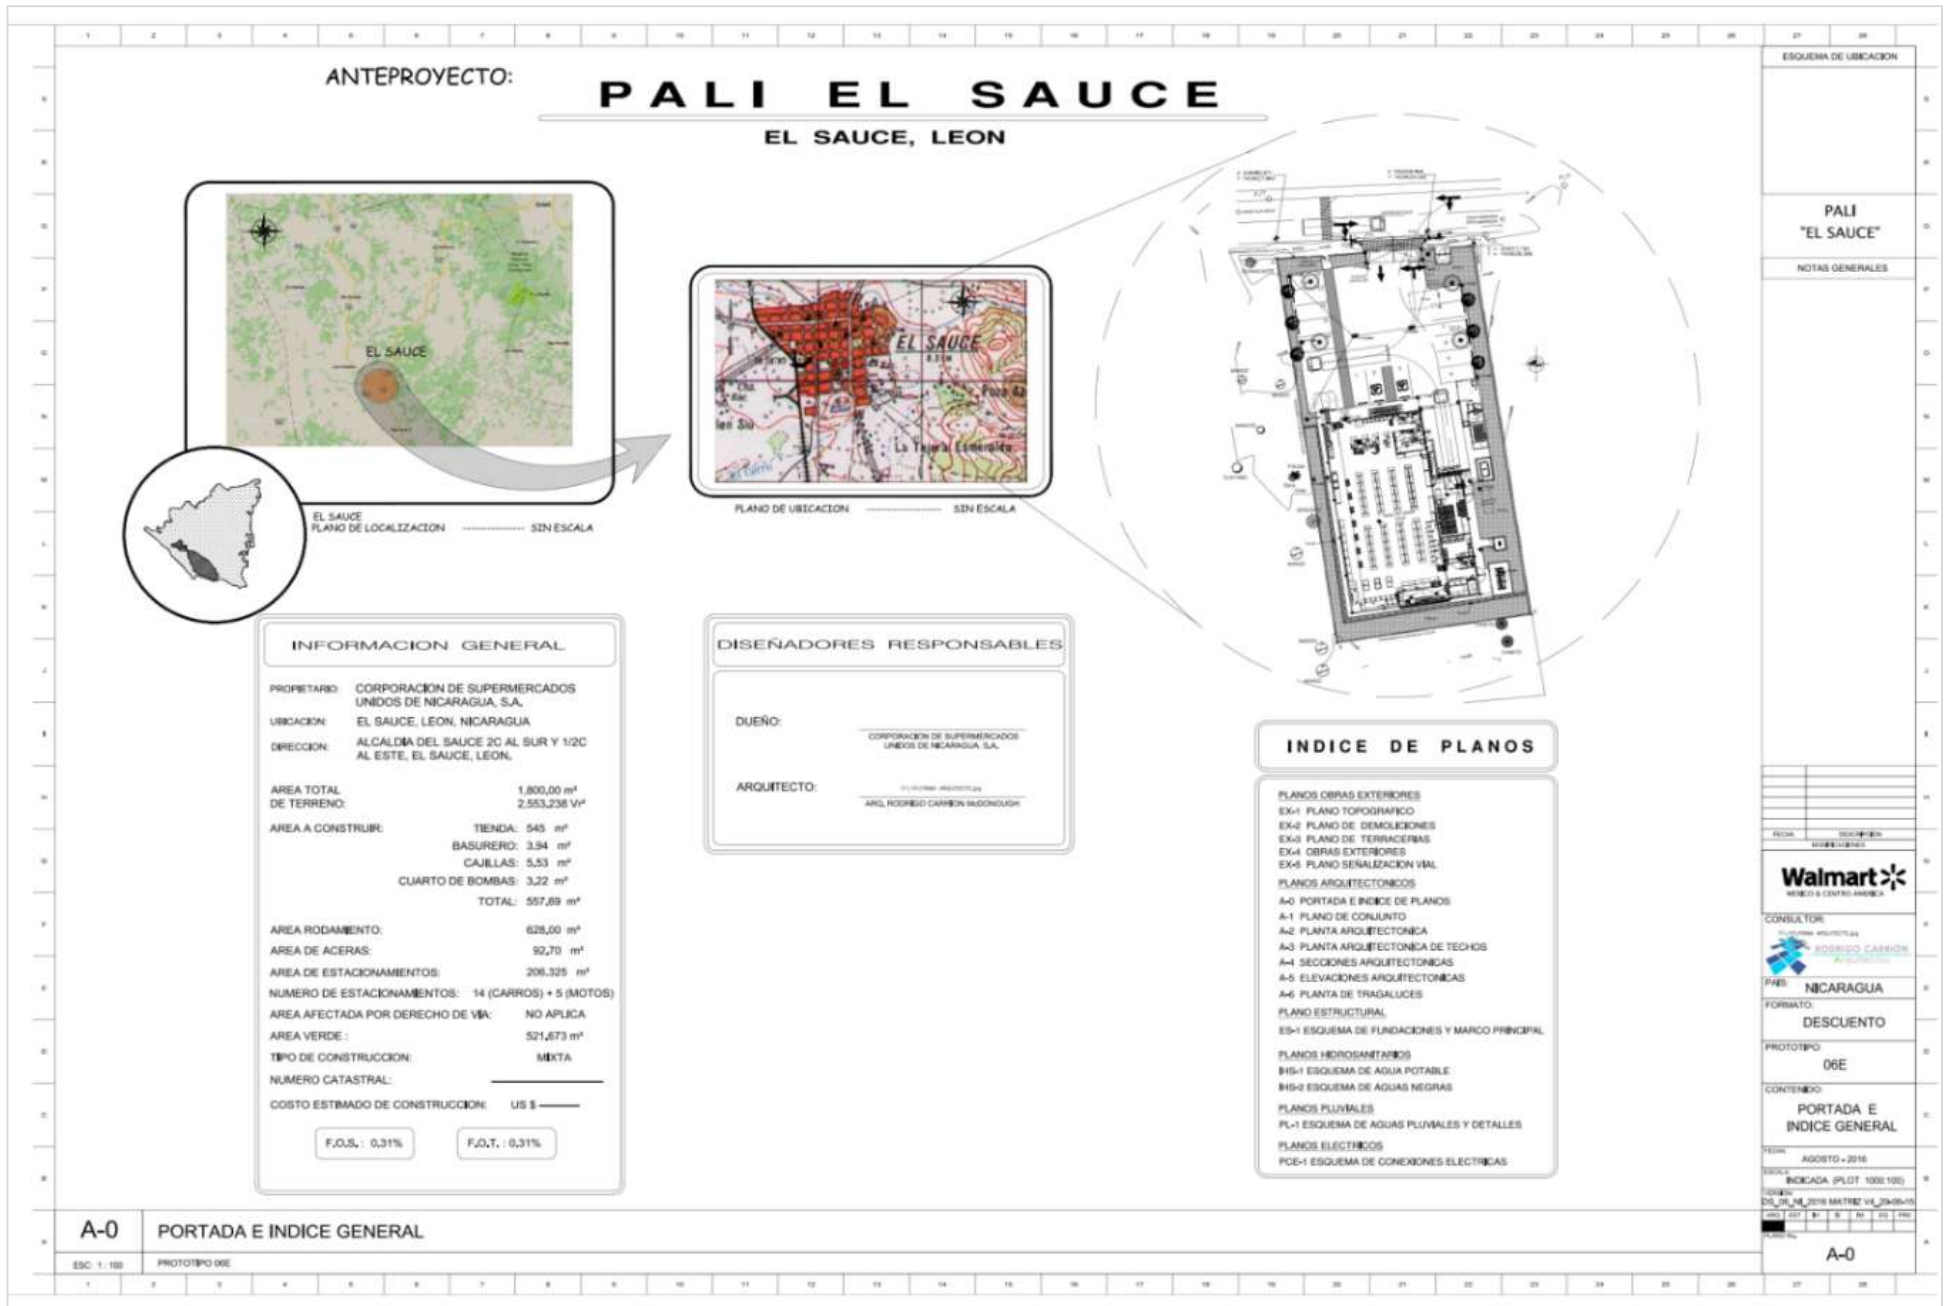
Portada de Planos de Anteproyecto Pali El Sauce, León. Fuente: Elaboración Propia.
